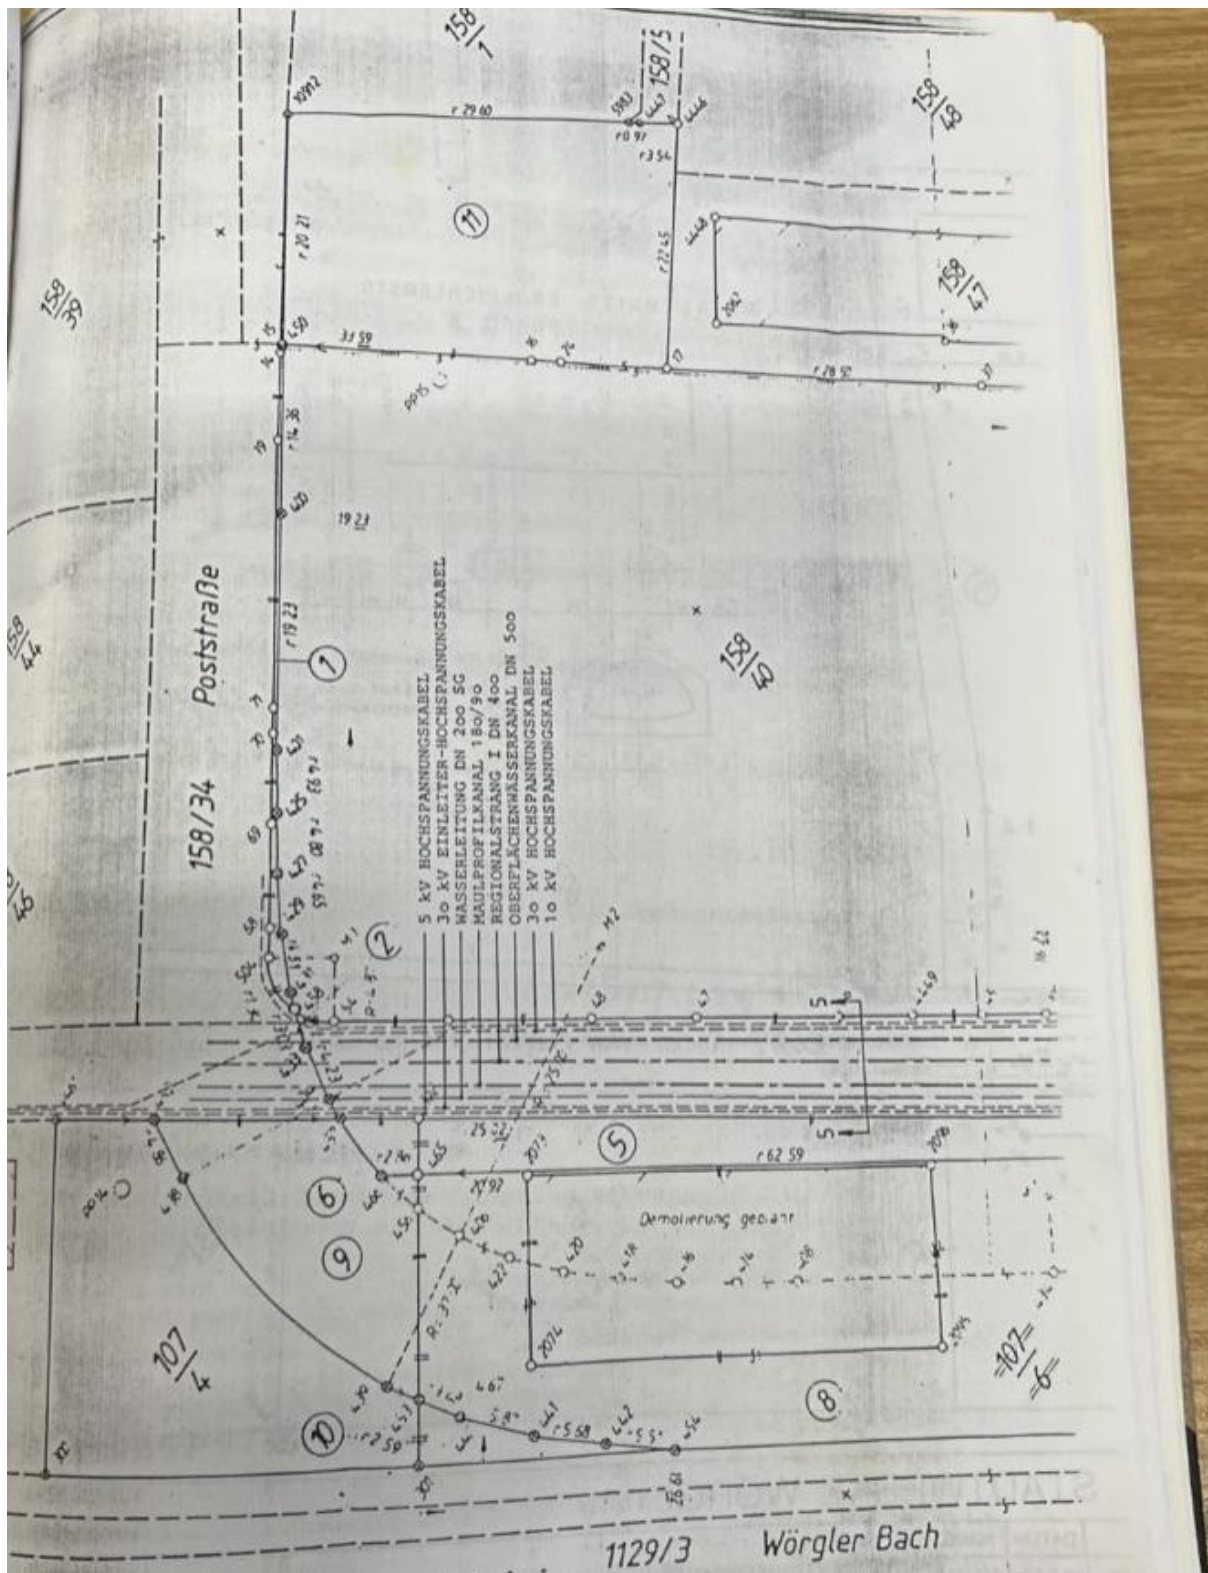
Lageplan Leitungstrasse Stadtwerke Wörgl (TZ 1475/1992; Seite 1/2)
